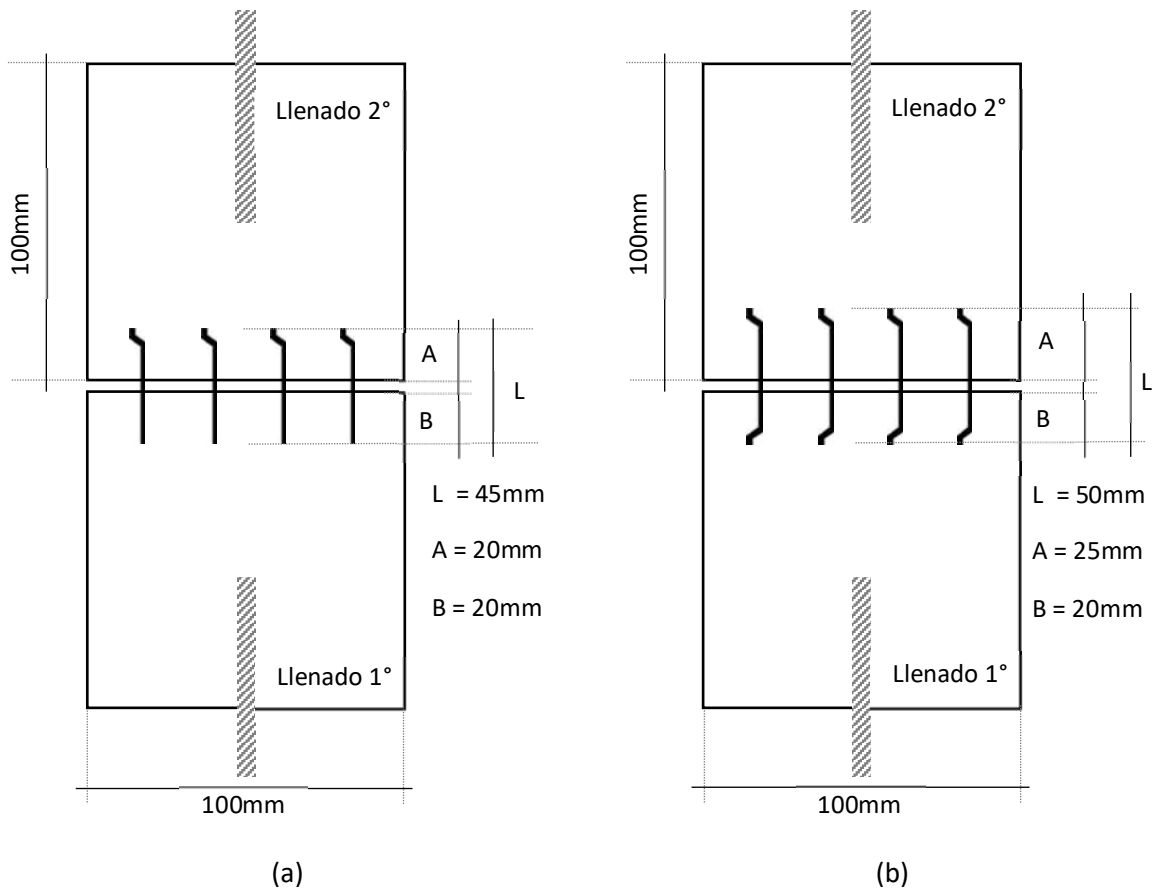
Configuración geométrica de las probetas utilizadas para el ensayo de pullout de un conjunto de 16 fibras: (a) fibra con extremo recto, (b) fibra con extremo con gancho.
